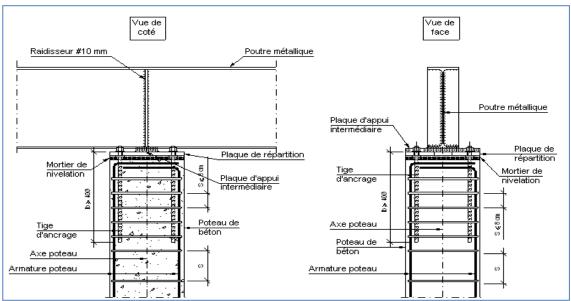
schéma de jonction poteau-poutre Source : les auteurs.
